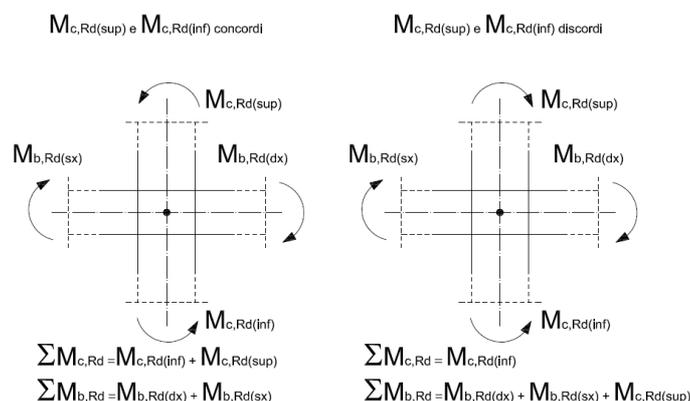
Progettazione in capacità dei pilastri
